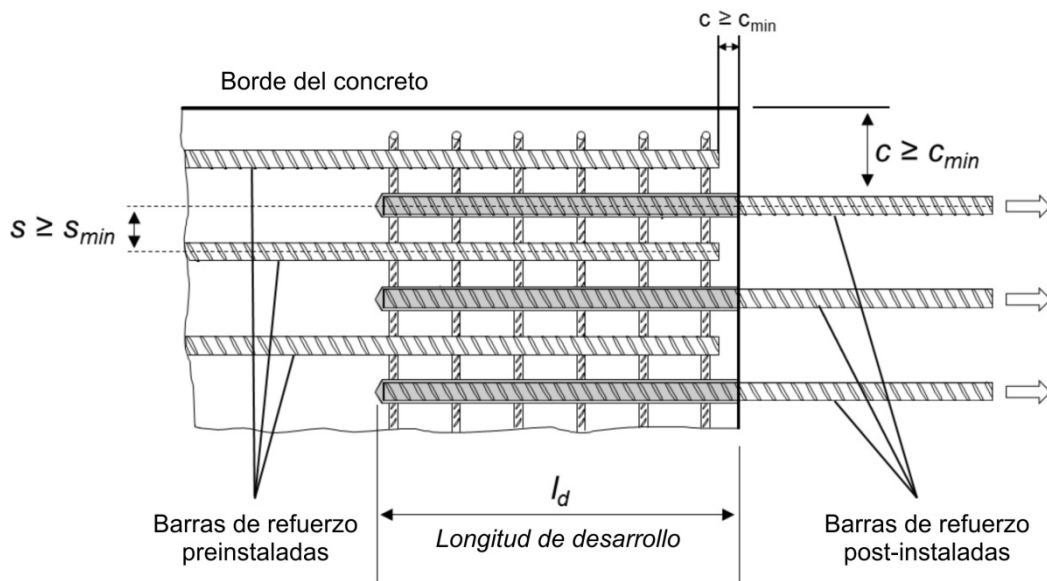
PARÁMETROS DE INSTALACIÓN PARA BARRAS DE REFUERZO POST-INSTALADAS
